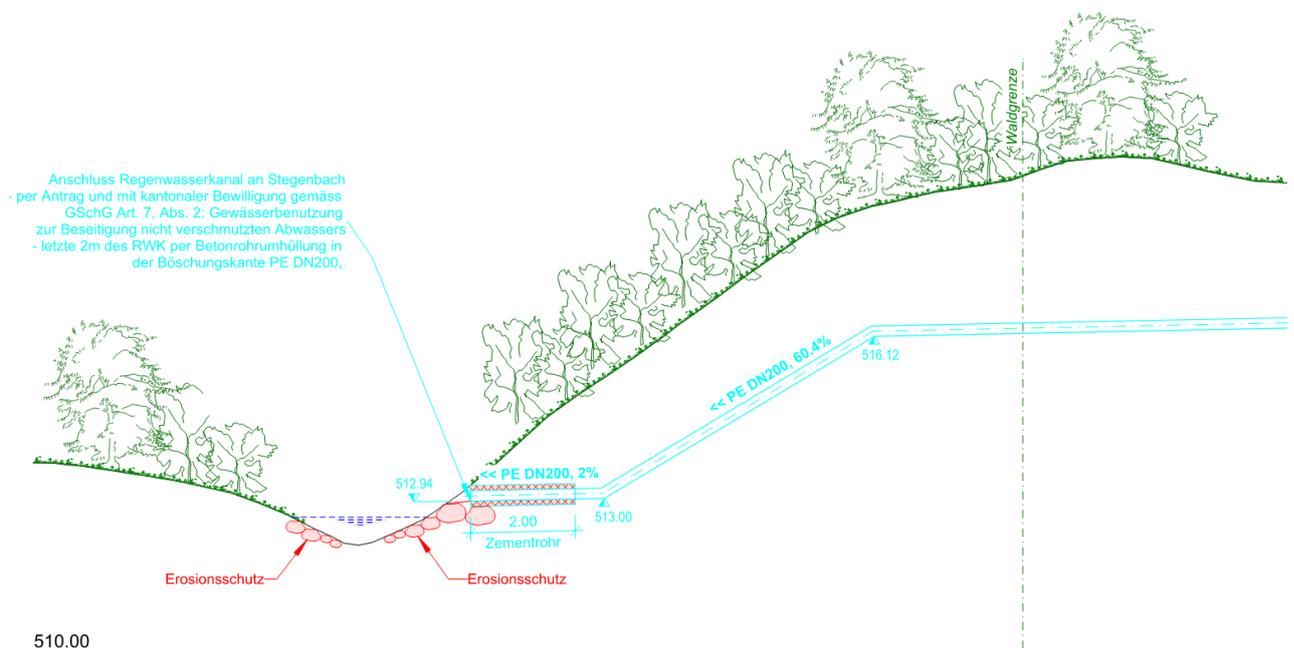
Ausschnitt Längsschnitt 2725-305 – Anschluss Stegenbach
